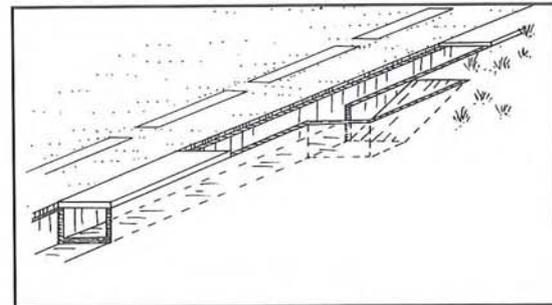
Las rampas de escape de los drenajes perimetrales situadas cada 25 m sirven para evitar que estos elementos constituyan trampas mortales para los animales.
